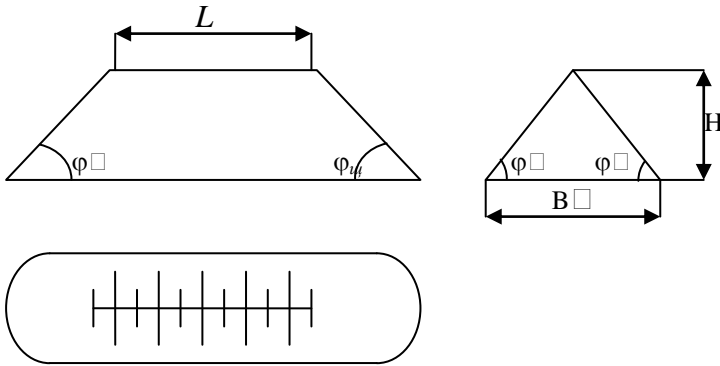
Розрахункова схема штабеля щебеню
